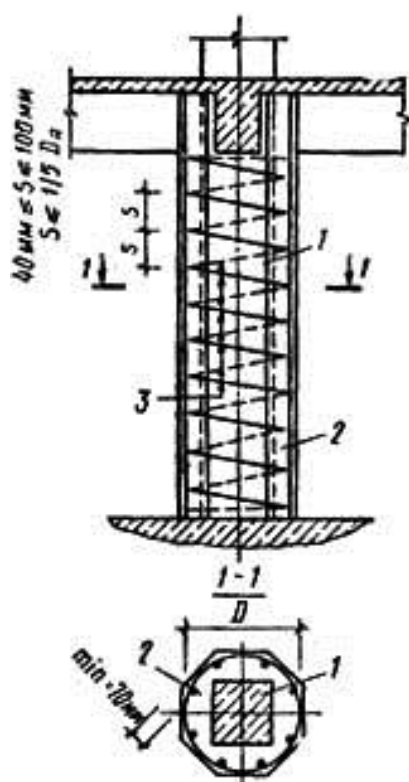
Усиление колонны обоймой со спиральной арматурой: 1 – усиливаемая колонна; 2 – обойма; 3 – спиральная арматура
